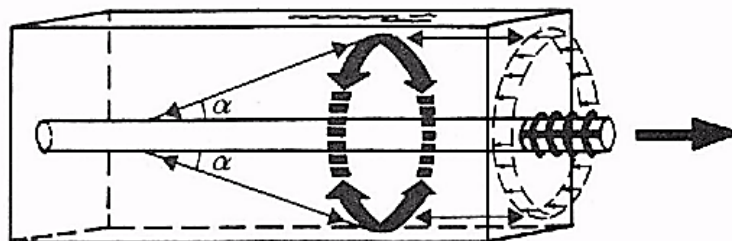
Formação do anel de tração no concreto - Modificado de Tepfers (1979).
